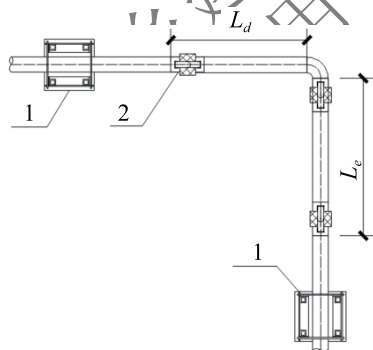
压力管道隔震柔性连接水平构造示意图 b
